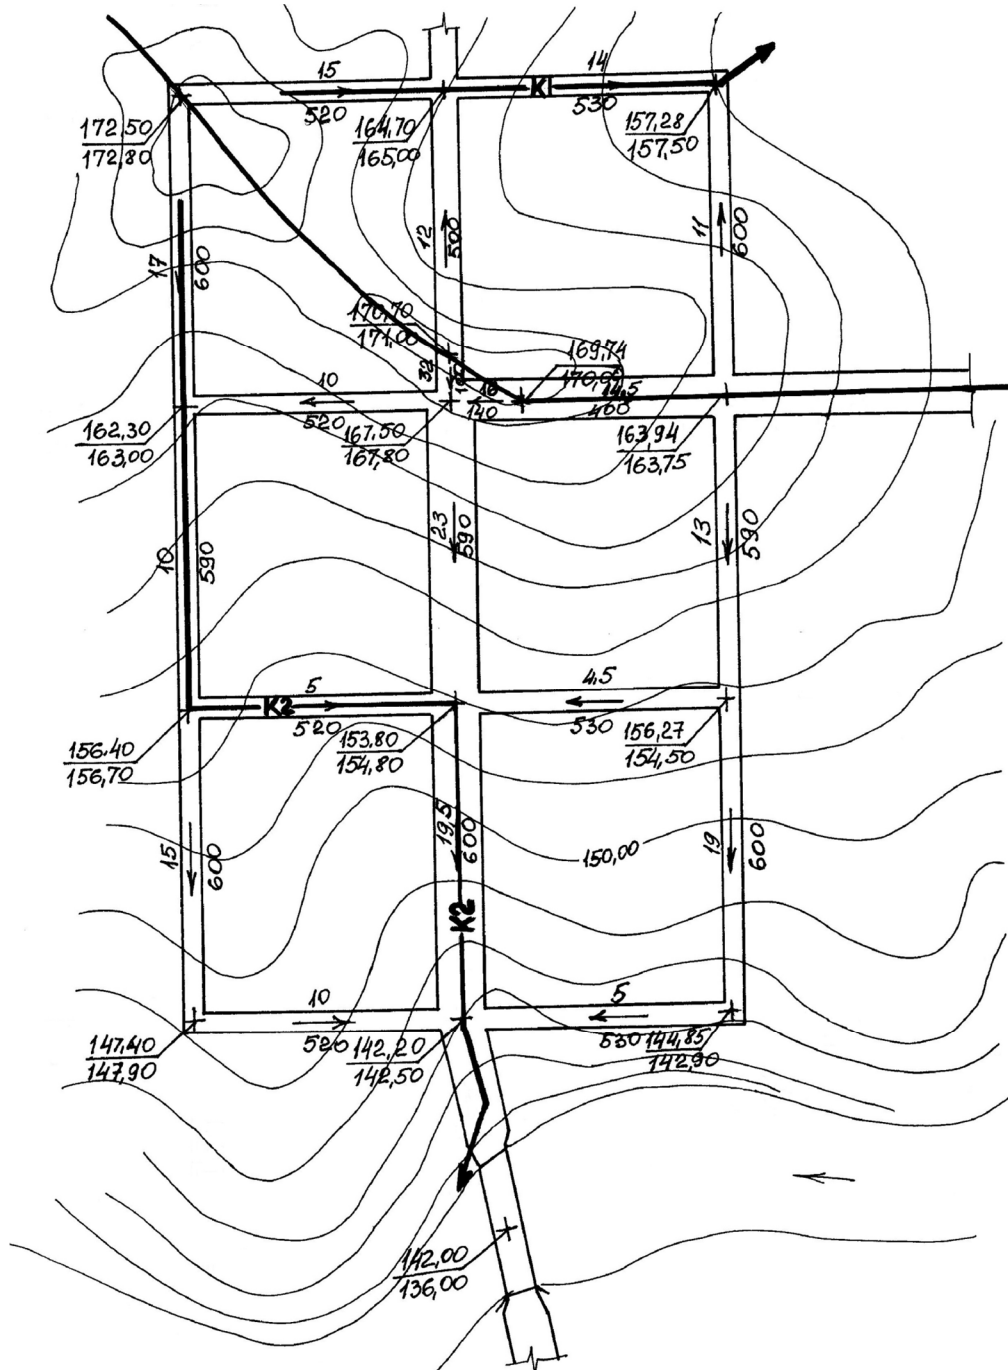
Фрагмент плану з червоними позначками і поздовжніми ухилами
